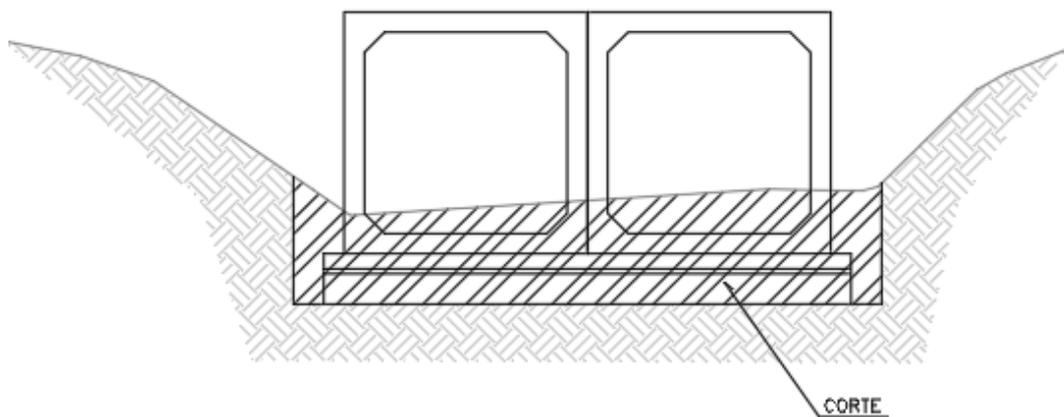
Seção tipo do corte de terraplanagem 2/4
